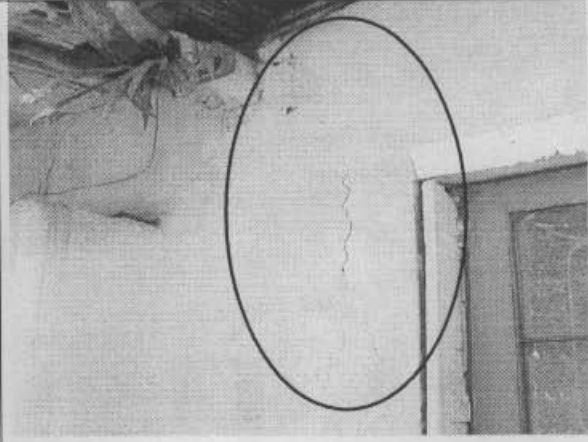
Agrietamiento de muros en el sector A del inmueble.
